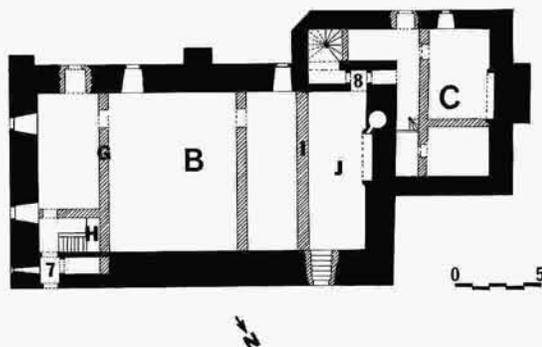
PLAN DES BÂTIMENTS DU « DONJON »
